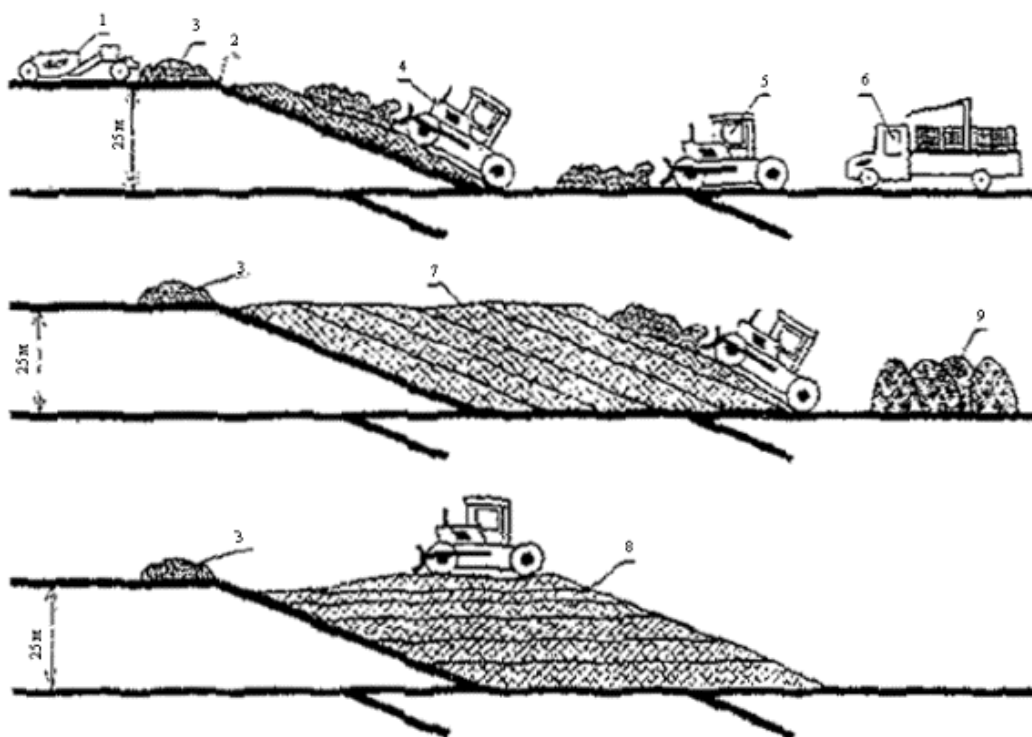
Схема укладки отходов методом "надвига" (снизу вверх)
